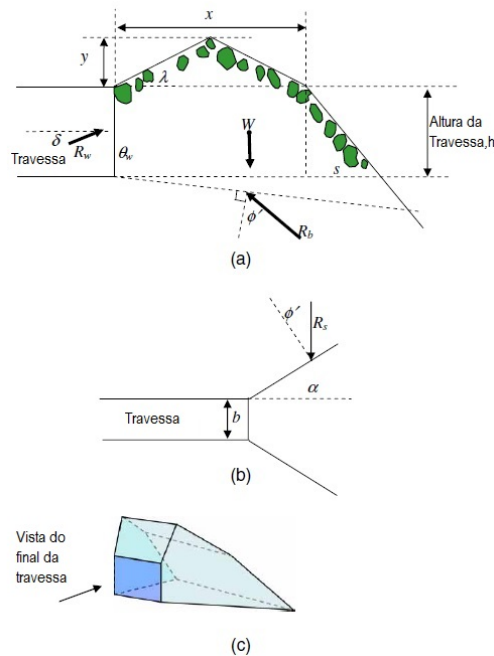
Mecanismo de falha para o prisma lateral de balastro no caso em que o final da travessa é empurrada contra o balastro: (a) Corte da secção ; (b) vista plana; (c) vista 3D (Le Pen e Powrie, 2011).
